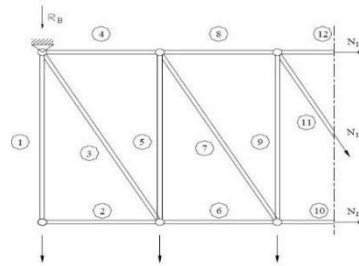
Simplificação do contraventamento da cobertura para vida de Pratt, com a fachada de empena a sucção.
